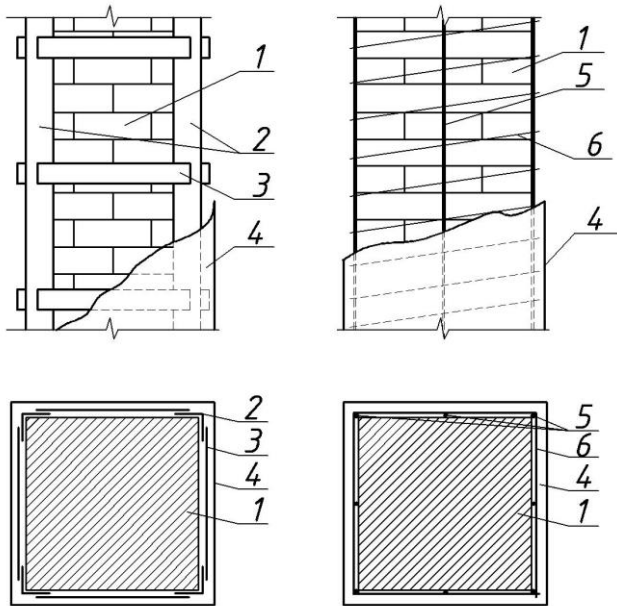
Підсилення кладки обіймами: *a* – металевою; *б* – штукатурно-армованою: 1 – кладка; 2 – кутики; 3 – планки;
